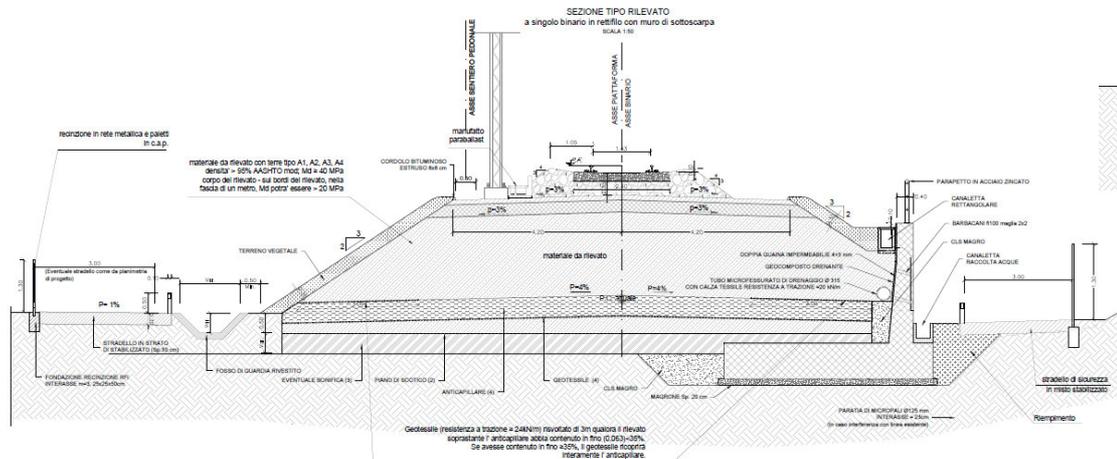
Corpo stradale ferroviario – Sezione tipo con muro di sottoscarpa
